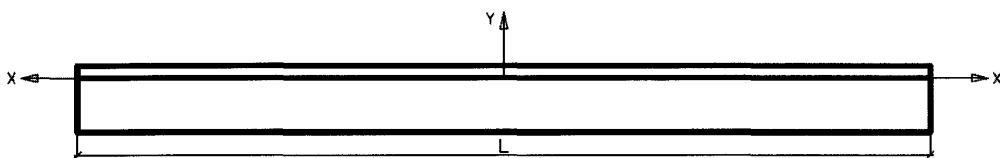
Продольная схема деревожелезобетонной балки с принятой системой координат
